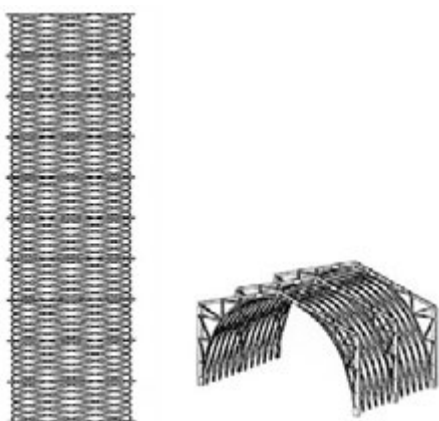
Portcullis House w Londynie, Architektura: Hopkins. Konstrukcja: Arup, [266].
